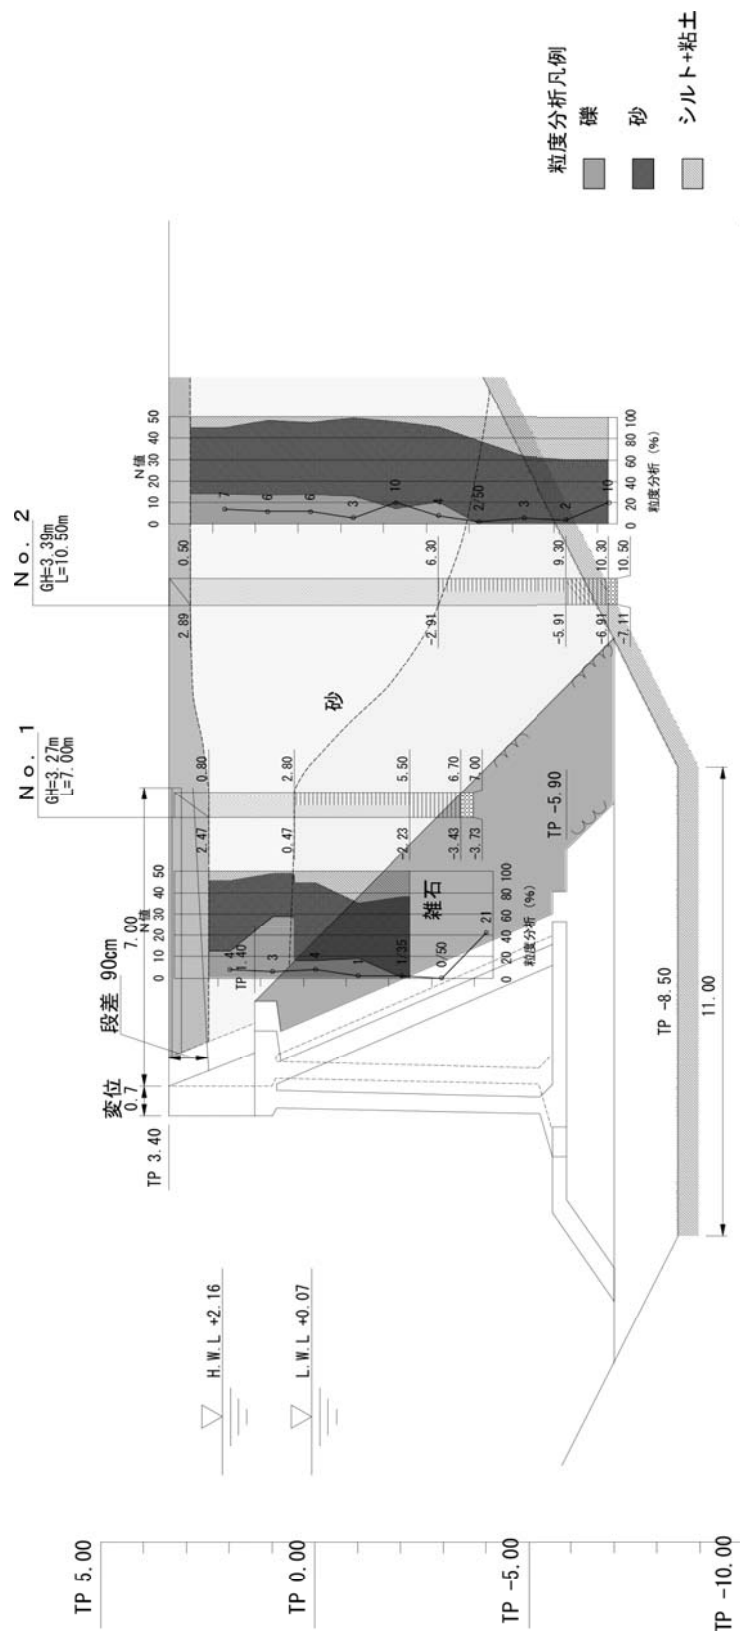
中央埠頭北側-5.5m 岸壁の被災状況断面図
